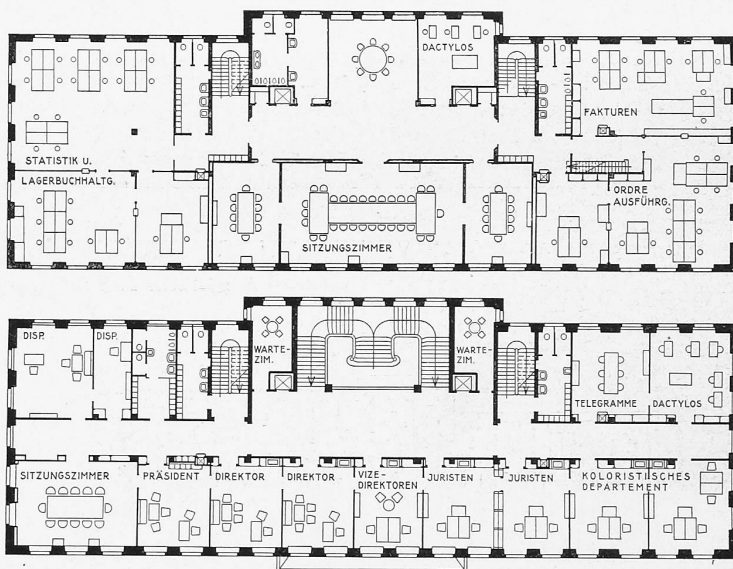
und 10. I. und III. Stock. — Grundrisse, Masstab 1 : 500.
